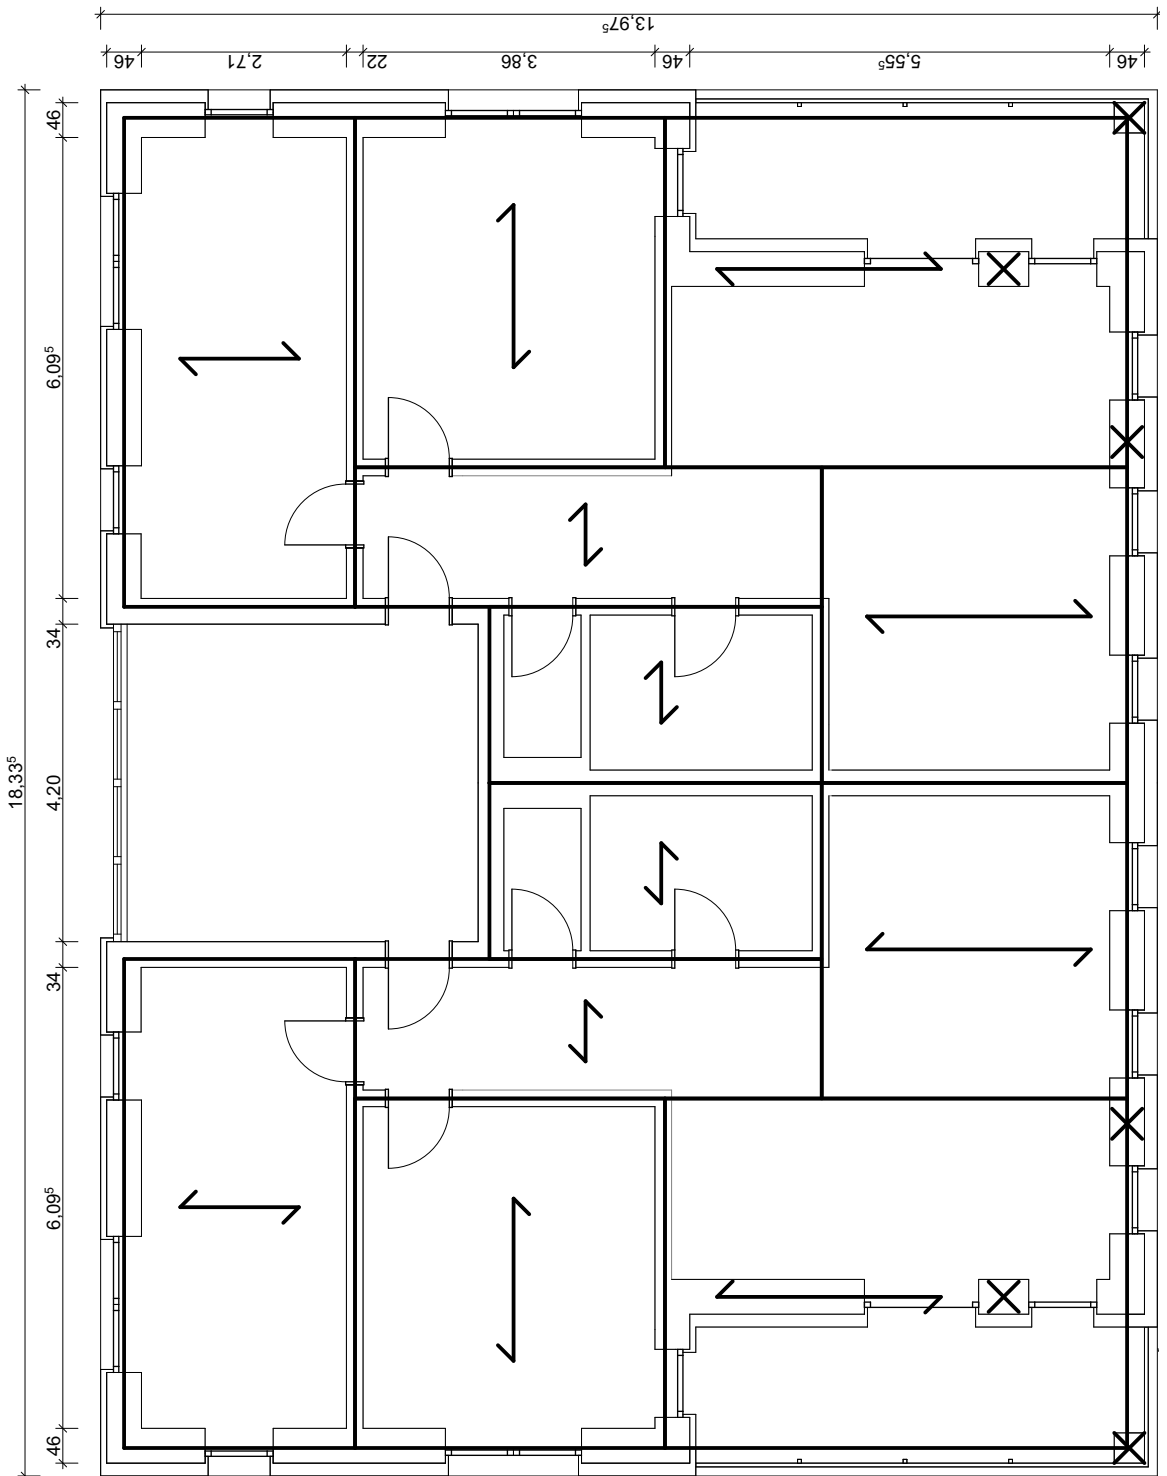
Statik 1. und 3. Obergeschoss M 1:100
